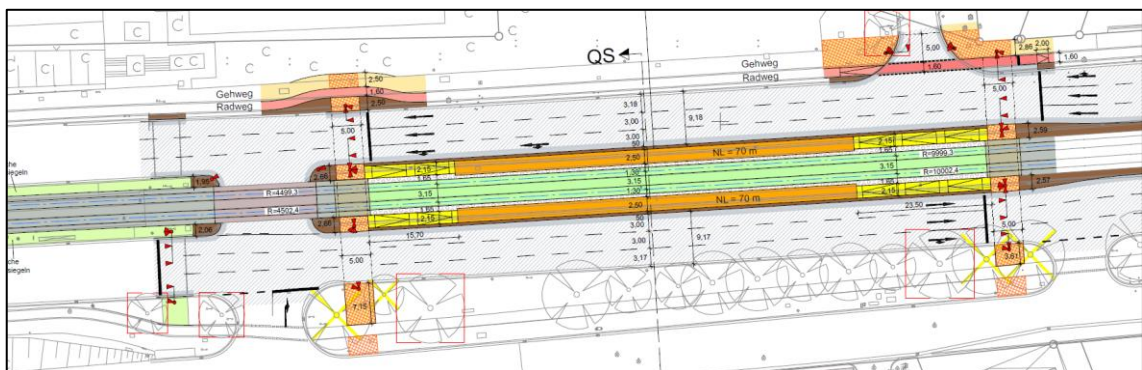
Ausschnitt Lageplan Variante 2 (MBU), V2_VA0LA1
